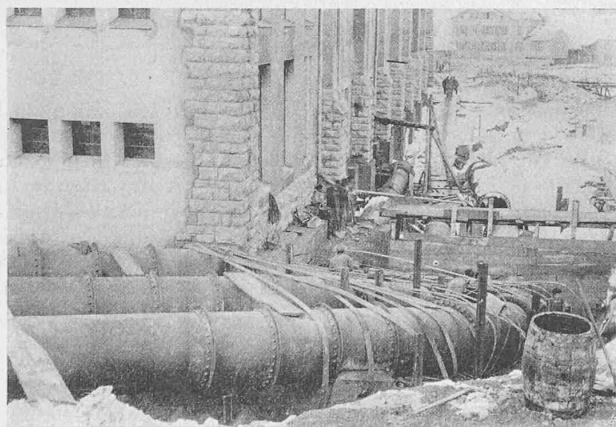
und 66. Verankerungsklotz VI an der oberen Maschinenhausecke, vor Einbetonierung der Druckleitungen (27. Febr. 1908).
